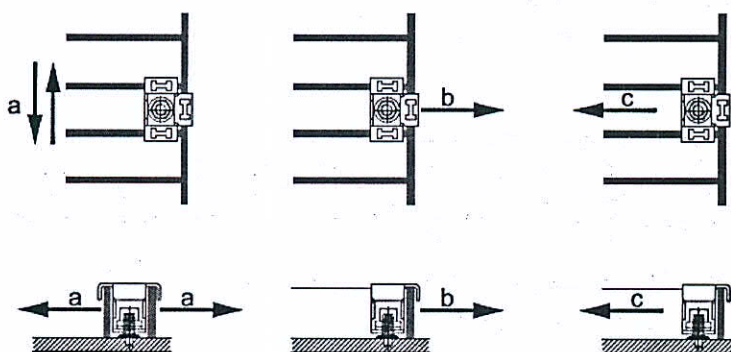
Схемы приложения нагрузки на крепежную скобу
